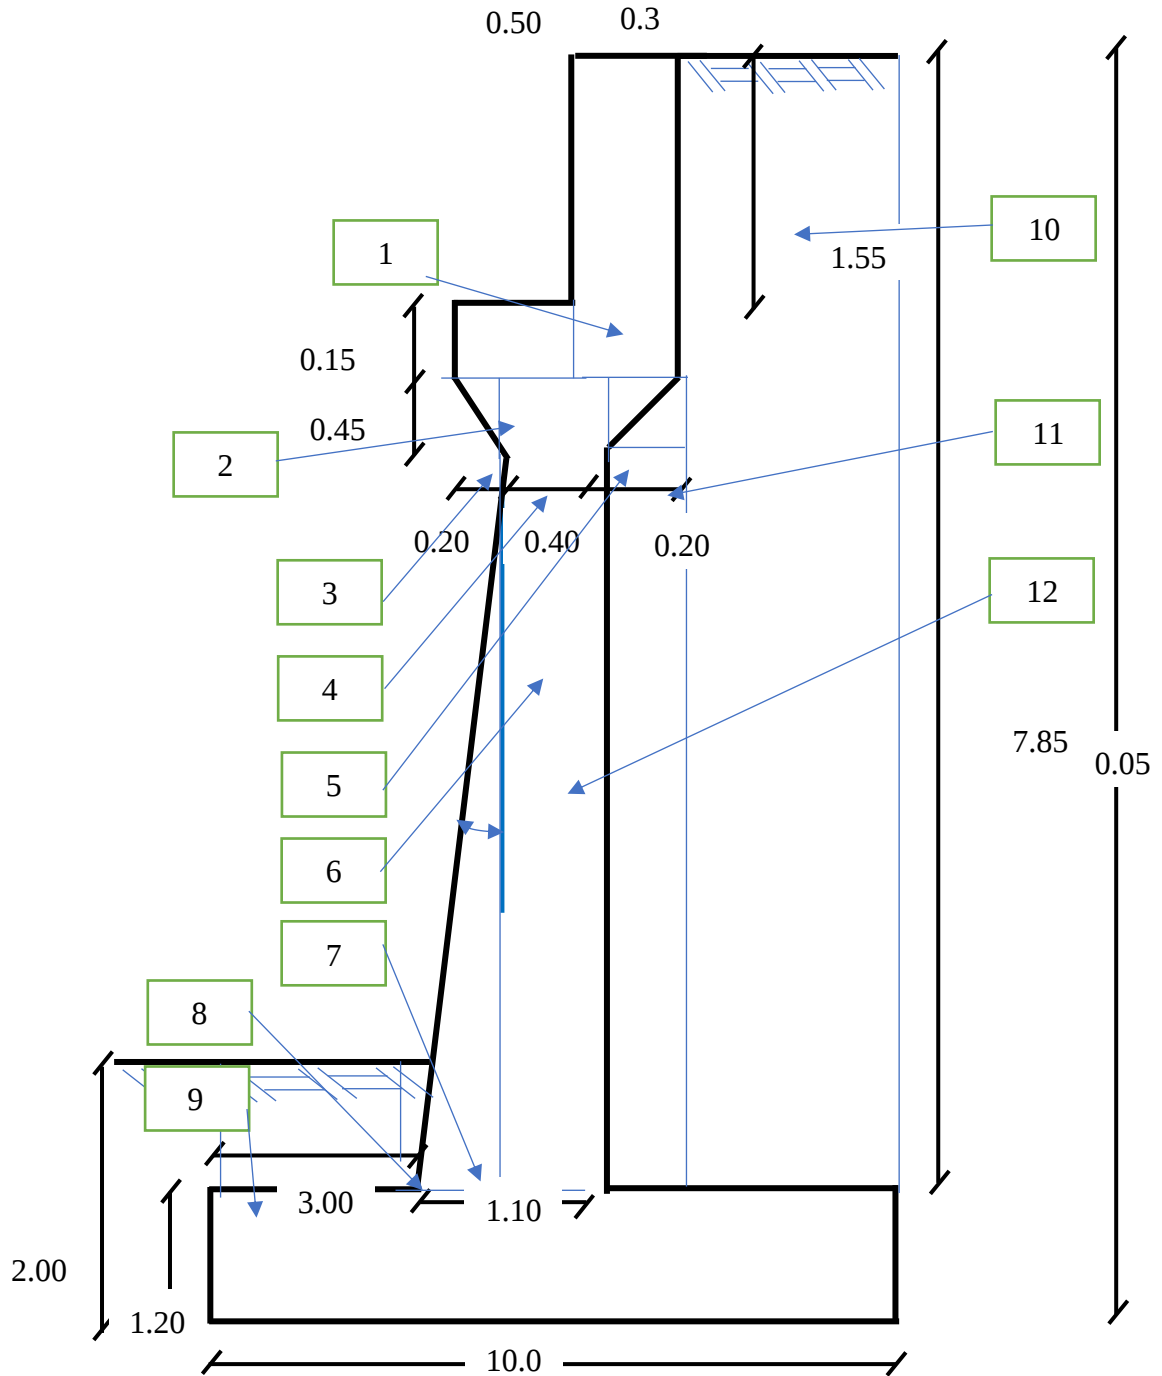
ESTRIBO-FUENTE: ELABORACION PROPIA
